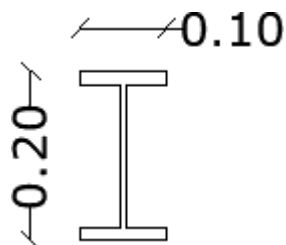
Sección de viga secundaria de acero. [Elaboración propia]
